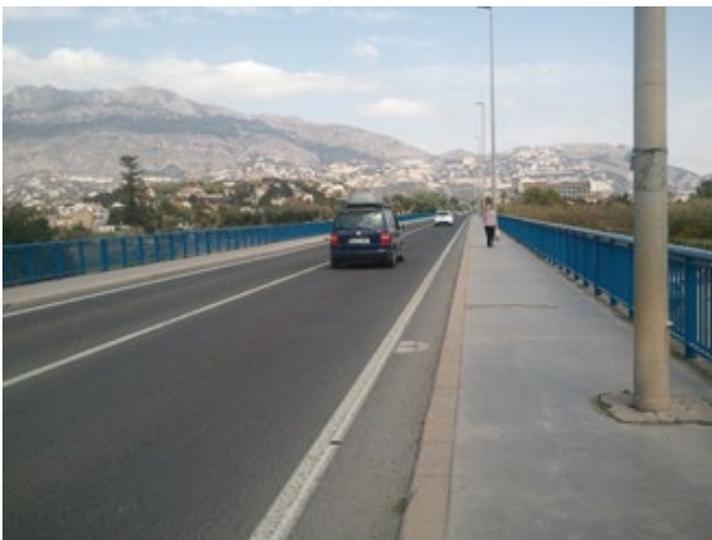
Microaglomerado en frío sobre pavimento de un puente.
